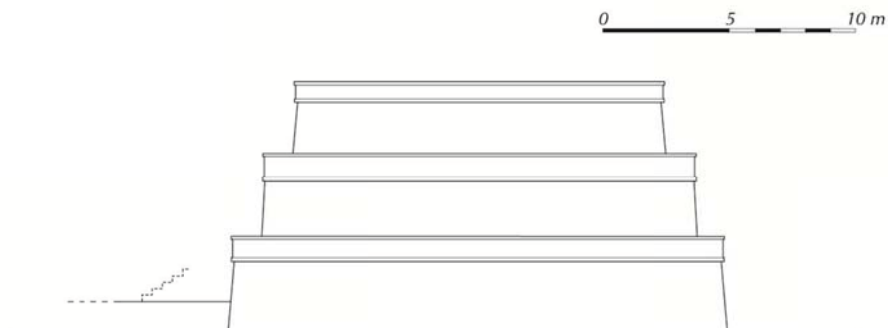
reconstruction architecturale du Soubassement 6O-4 et de son escalier d'accès jamais construit (Michelet 2011)
